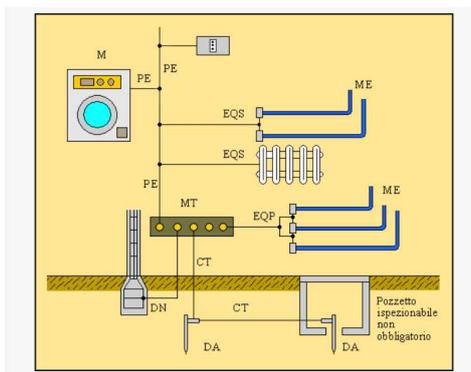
Schema elementi fondamentali impianto di terra (Fonte elektro.it)
